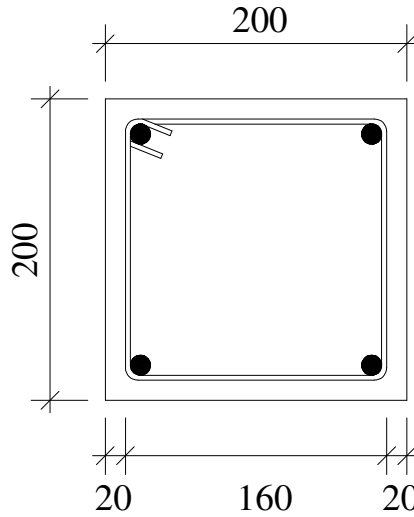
Test edilen kolon numunelerine ait donatı detayı ve kesit özellikleri
